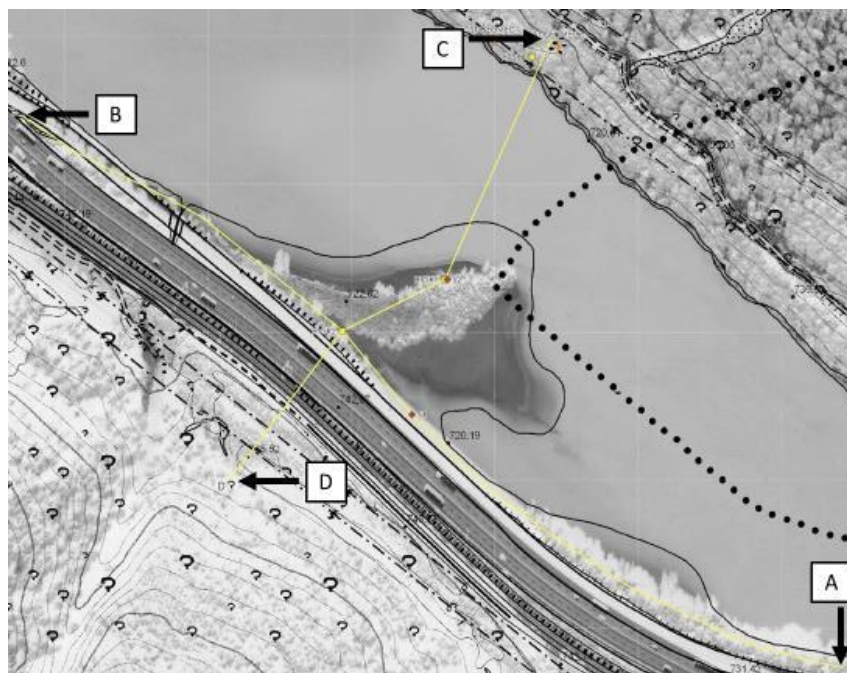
Stralcio dell'Allegato 3 che riporta le tracce delle sezioni in planimetria.
